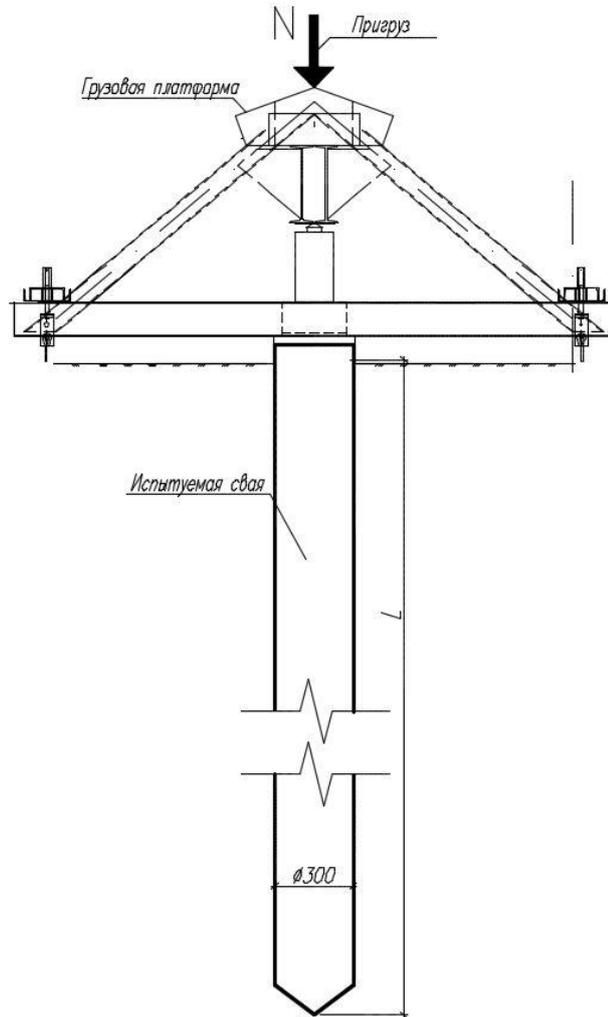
Конструктивная схема испытания свай статической нагрузкой
